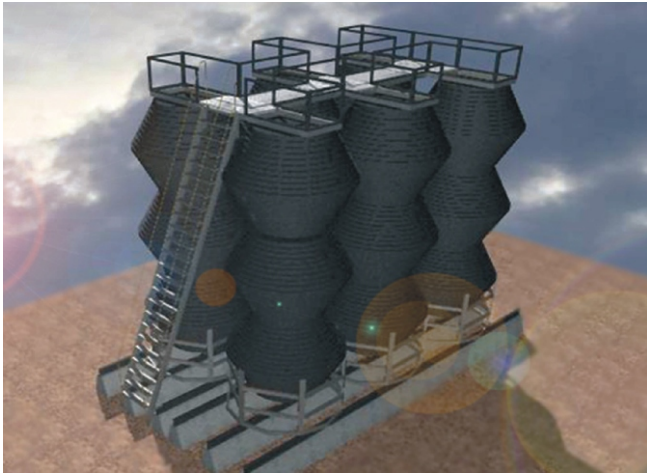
Загальний вигляд конструкції перетворюваного типу
